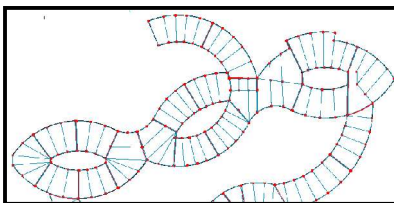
Plan de repérage de la structure métallique mixte avec sa trame.
